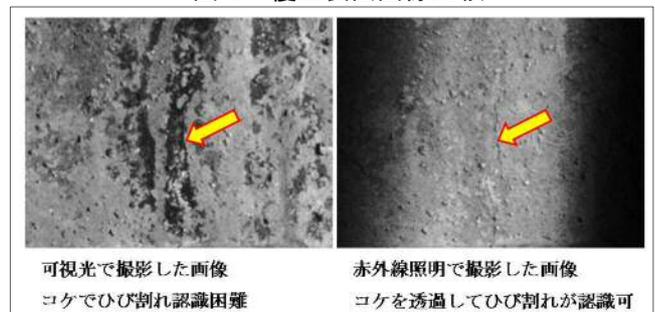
コケ付着箇所でのひび割れ撮影状況
